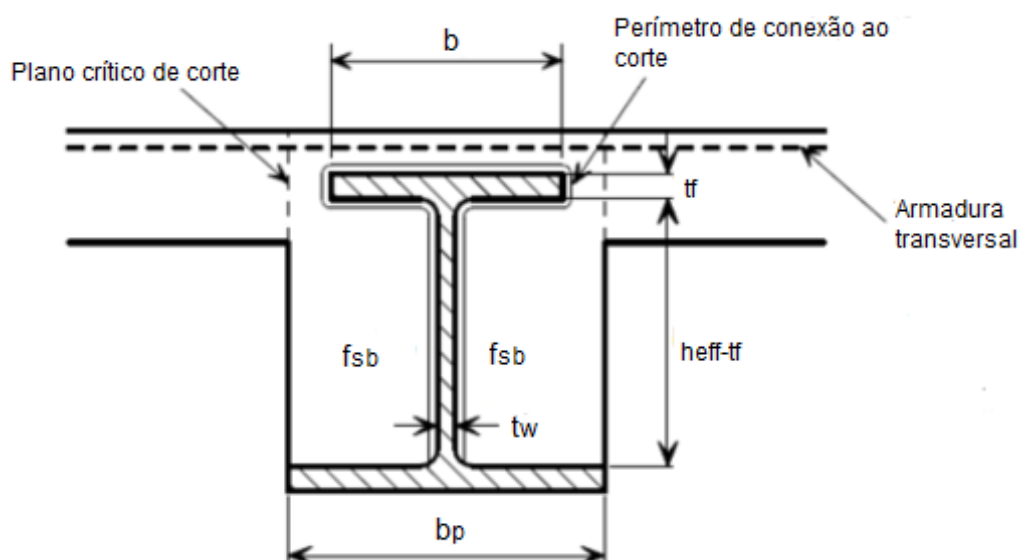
Transferência de corte ao longo da superfície interna da viga metálica, Viga IFB tipo A [24].
